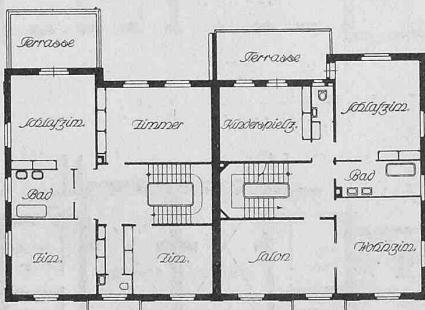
bis 9. Grundrisse der Häuser Lautengartenstrasse Nr. 4 und 6 und Schnitt von Nr. 6 (zu Tafel 22 oben). — Maßstab 1 : 400.
